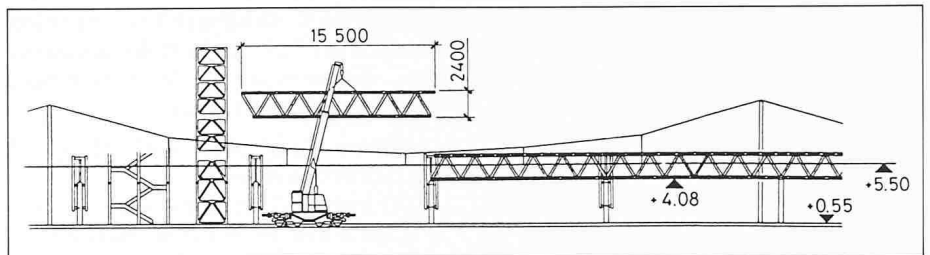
Montagevorgang mit vorgefertigten Stahlelementen
